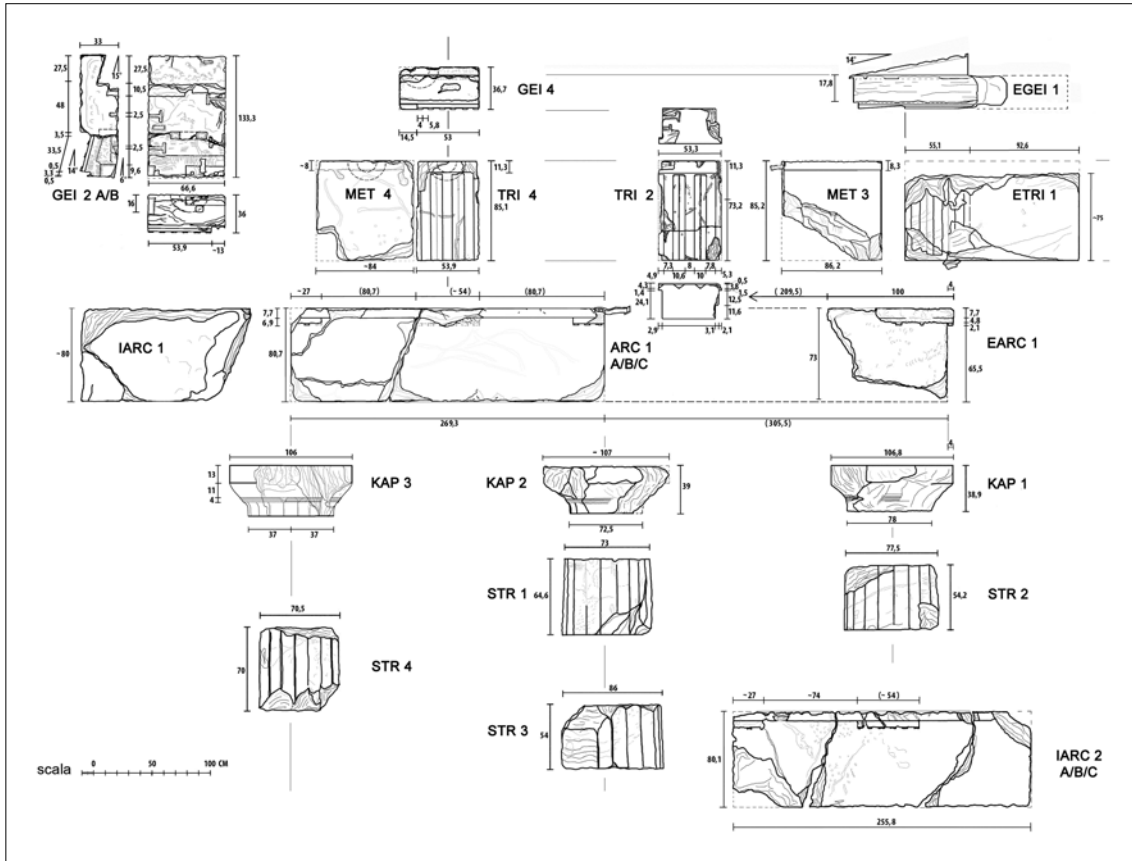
L' elementi elevati dell'architettura, tempio arcaico (rilievo: F. Gennatou)
